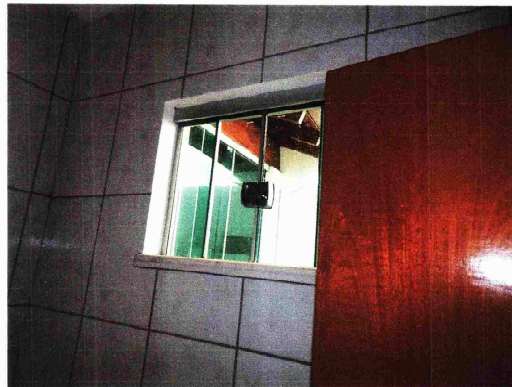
VISTA INTERNA FUNDOS PAREDE COM DEFEITO NA PINTURA
